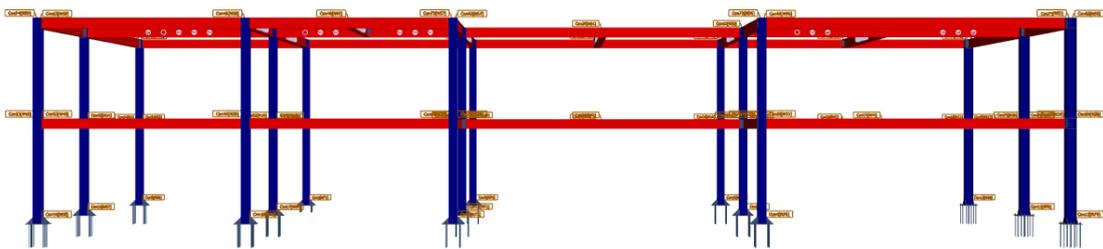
Estrutura de Aço – Estrutura finalizada vista frontal
